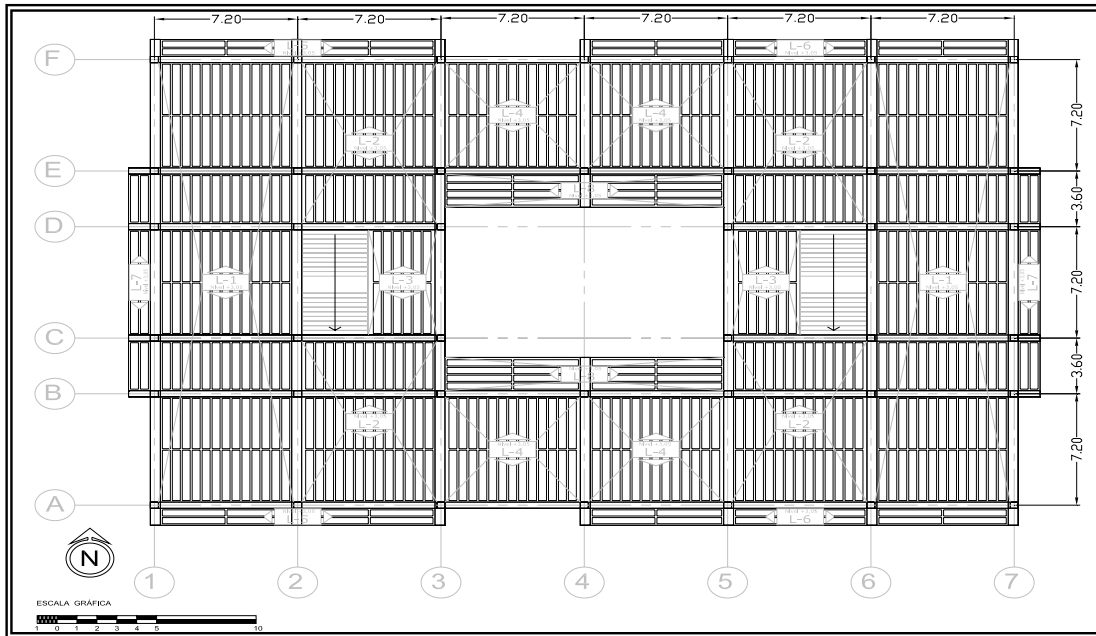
Plano de envigado en planta, niveles 1 y 2, mostrando la dirección de armado de losas
